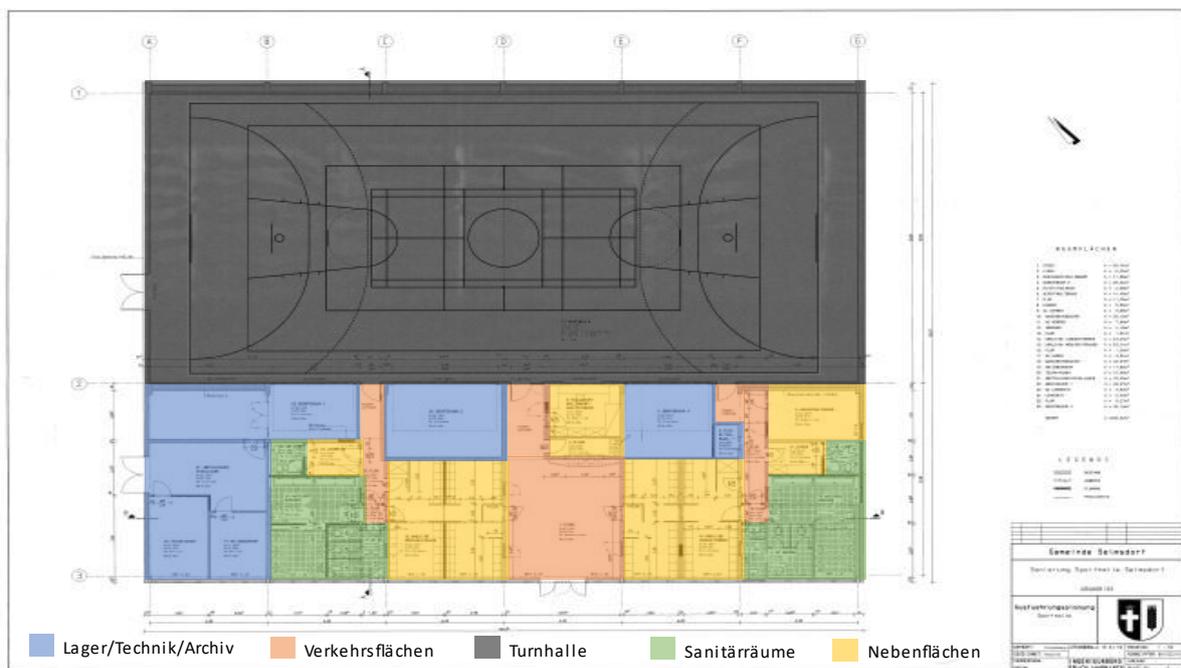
Zonierter Grundriss des untersuchten Gebäudes
